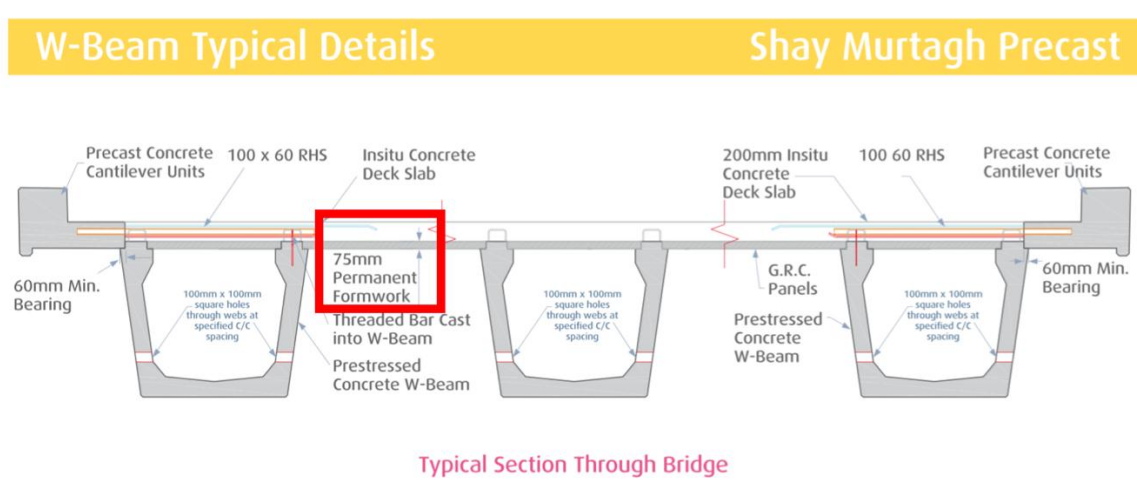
Características típicas de vigas em “W”. Excerto da Ficha técnicas das vigas pré-fabricadas, pré-esforçadas da Shay Murtagh
